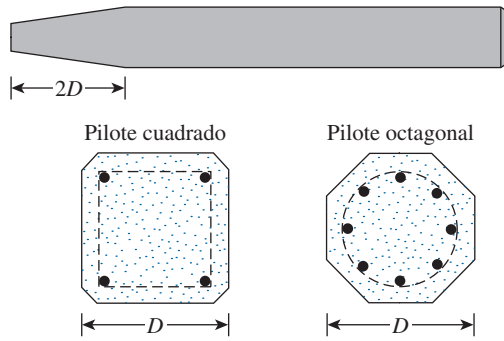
Pilotes precolados con refuerzo ordinario.
